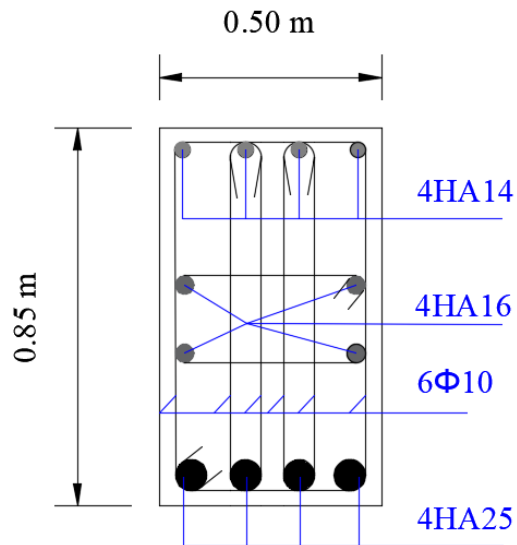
ferrailage de la poutre principale (50×85) en travée
